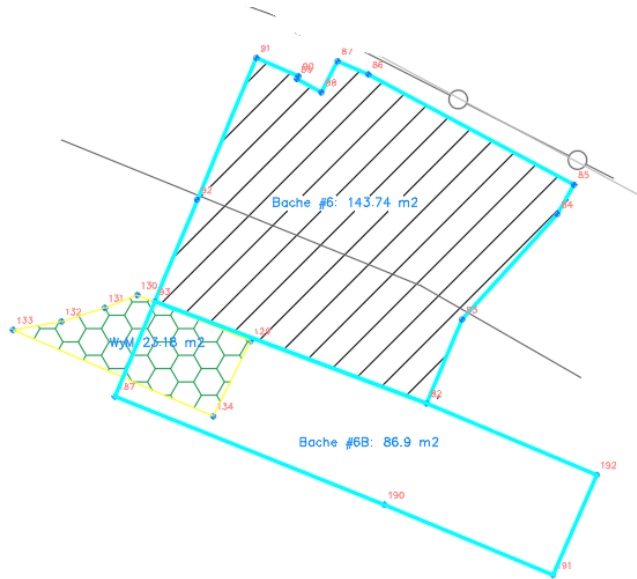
Vista en Planta de Bache #6 y 6B.
